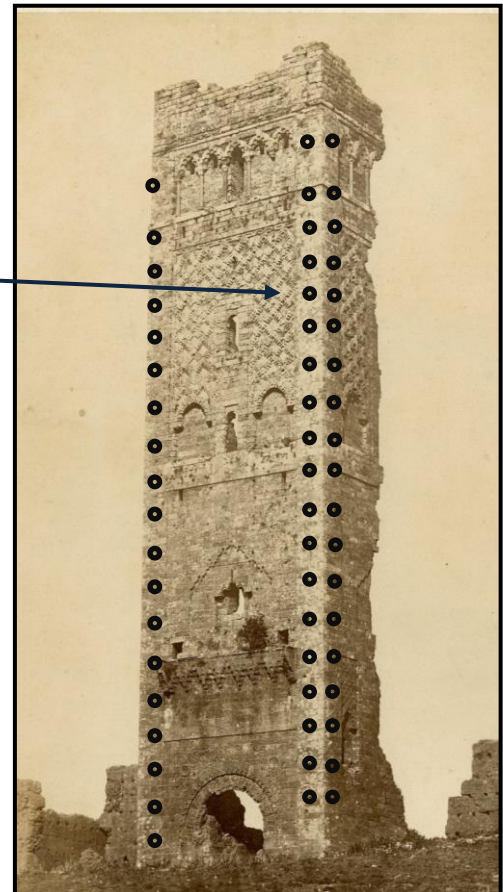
MINARET PENDANT LA RESTAURATION DE 1877, ELEVATION NORD.
